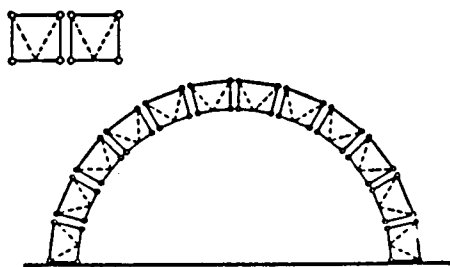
Disposição longitudinal das peças pré-fabricadas de quatro membros
